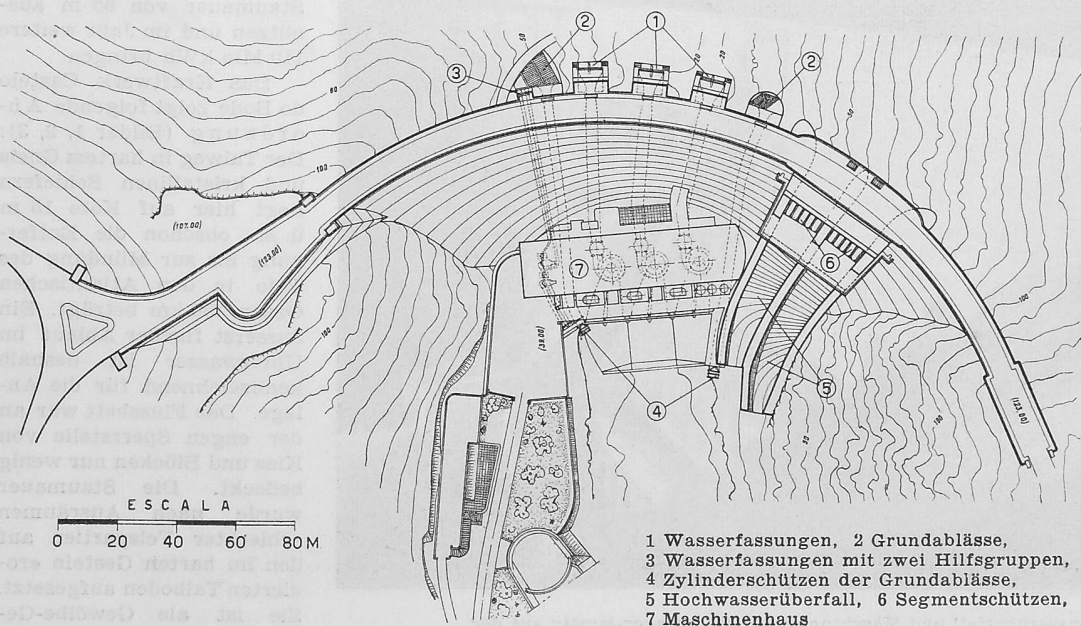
Lageplan von Staumauer und Kraftwerk Castelo do Bode, 1:2500
